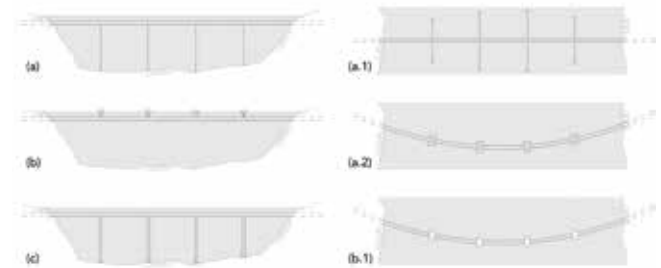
Alternativas de túnel sumergido flotante evaluadas. (a) TSF con elementos en tracción, (b) TSF con cajones flotantes, (c) TSF con pilas cimentadas en el fondo marino
